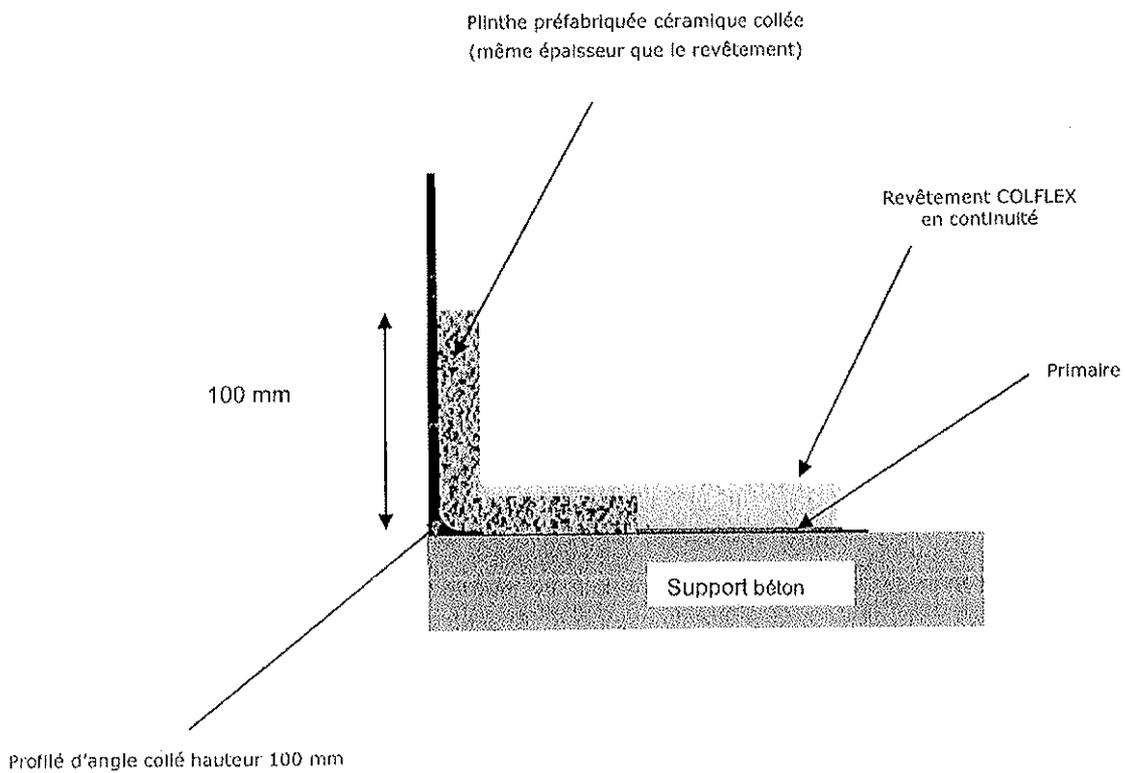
Traitement des rives – Cas des locaux classés E2 pour chape ou dalle adhérente
